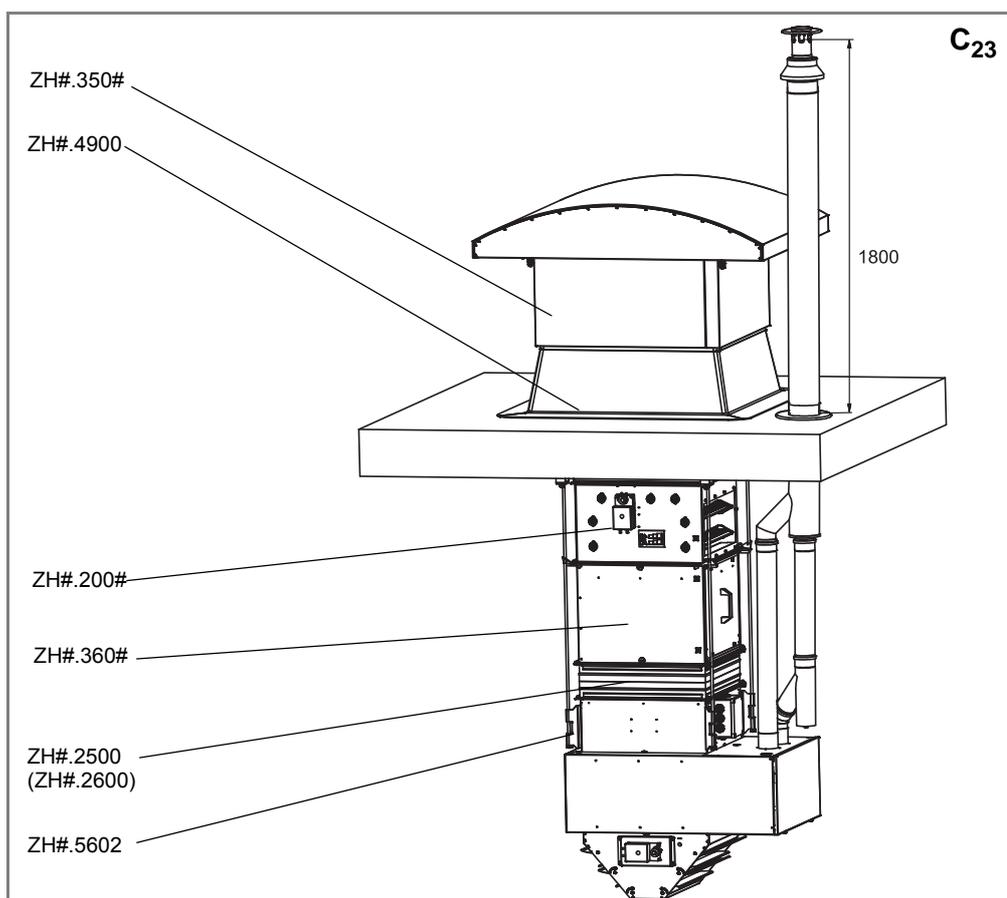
Deckenmontage eines Mischluftgerätes mit coaxialer Abgasleitung
